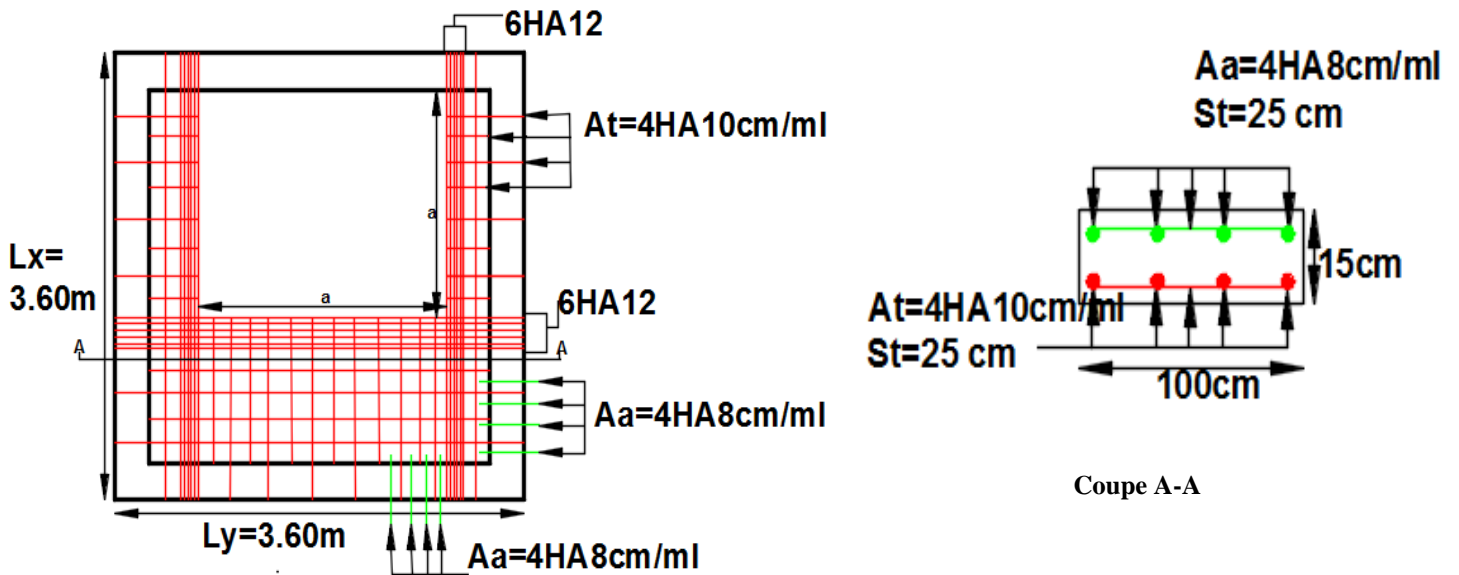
Ferrailage de la dalle pleine de la cage d’ascenseur
